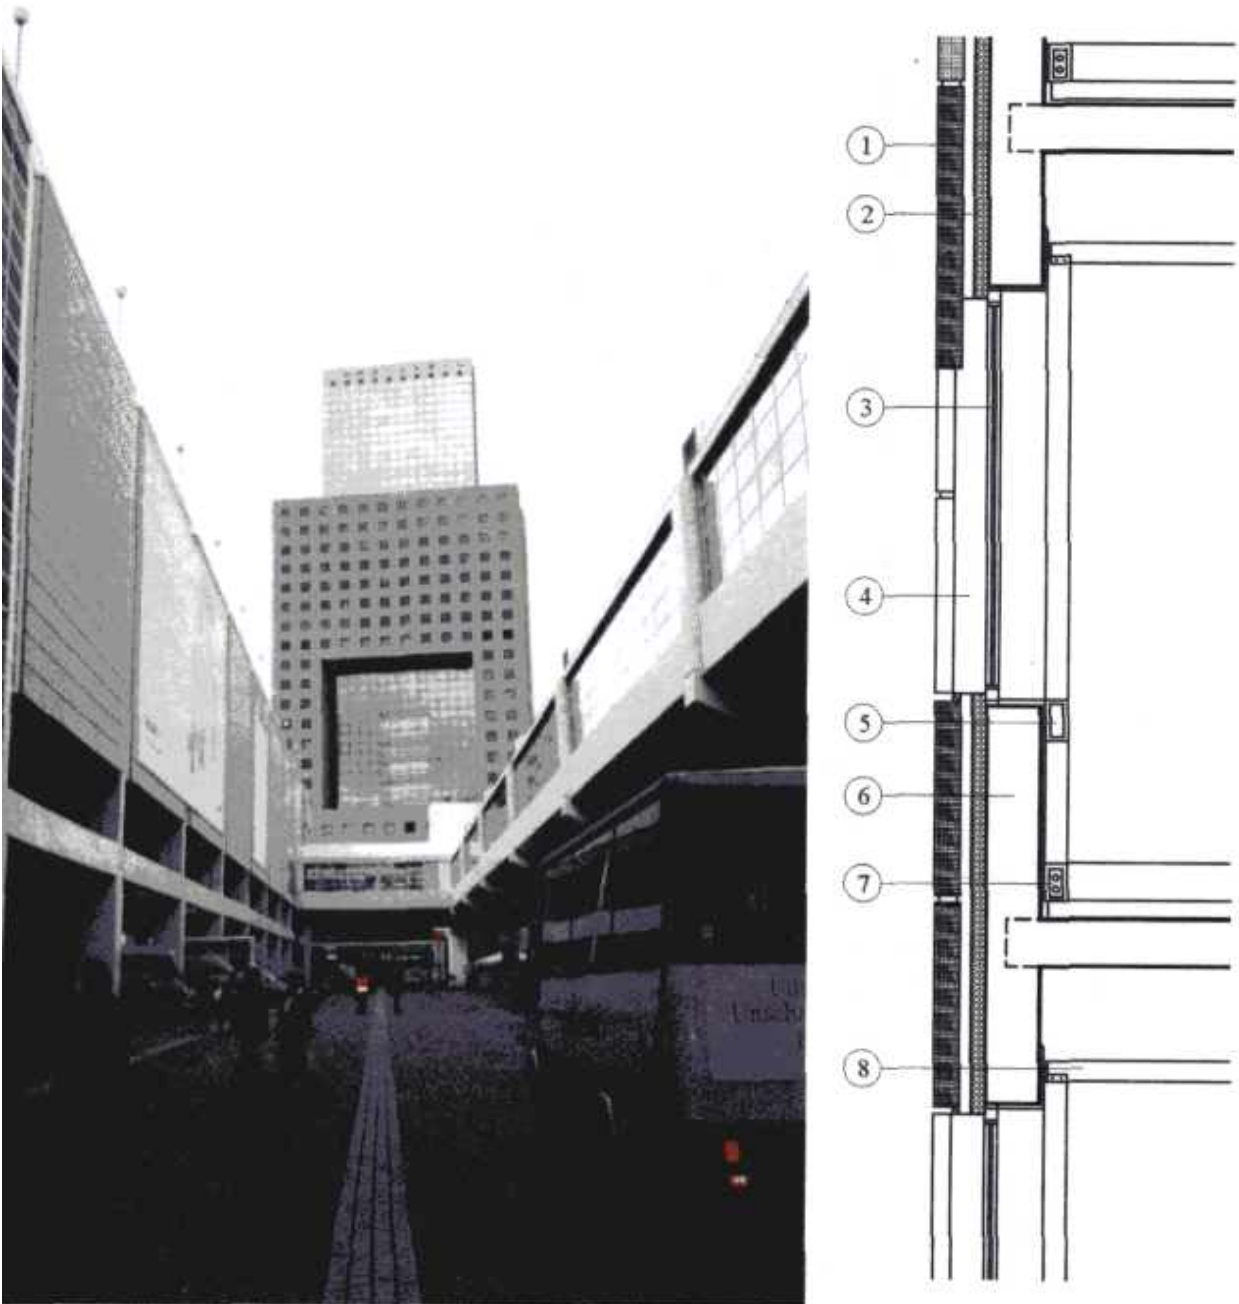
Пример облицовки монолитной наружной несущей стены плоскими декоративными бетонными плитами. Павильон в комплексе международной ярмарки Франкфурт-на-Майне. Арх. О.М. Унгерс. 1987 г.: а - общий вид павильона «дом - ворота», б - сечение наружной стены: 1 - облицовочная плита, 2 - утеплитель, 3 - оконный блок, 4 - алюминиевая облицовка откосов, 5 - канал электропроводки, 6 - несущий слой стены, 7 - отопительный прибор, 8 - подвесной потолок
